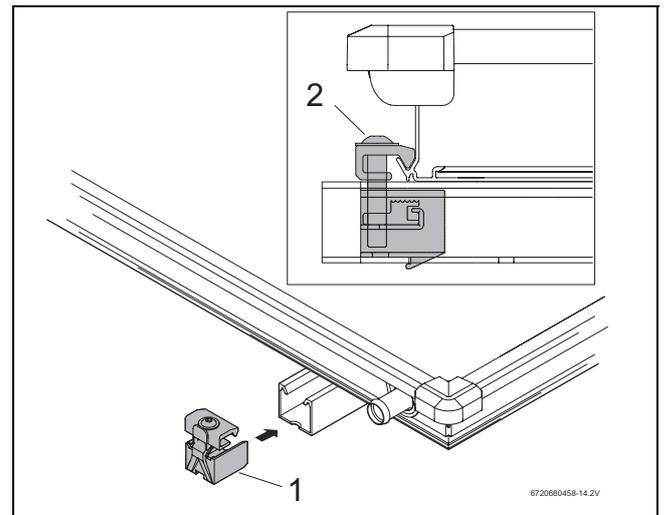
Giunto di fissaggio unilaterale, lato sinistro
